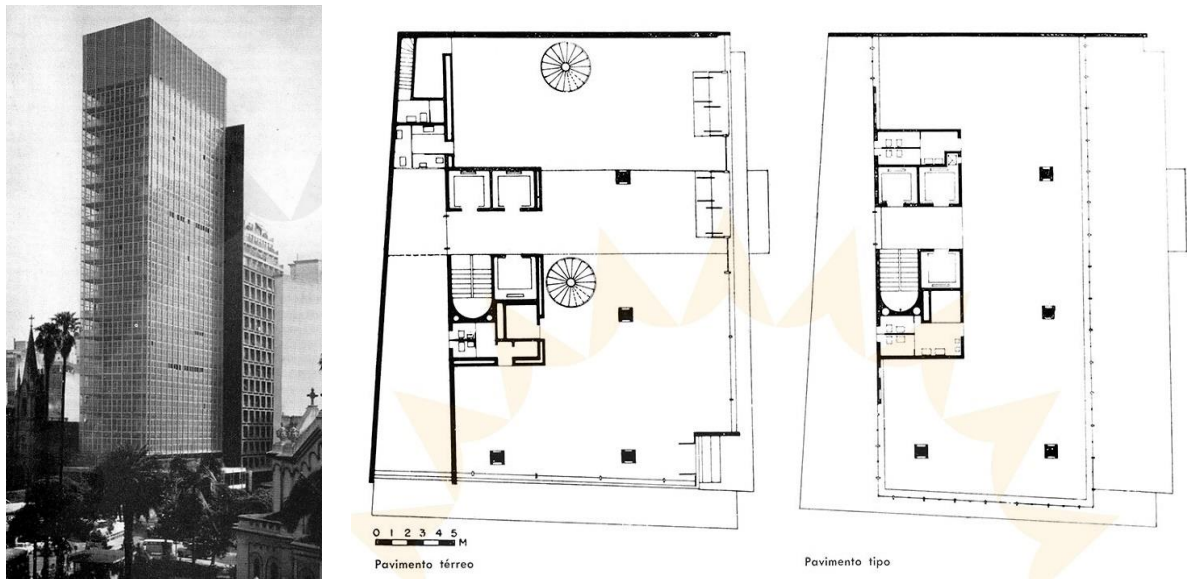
Vista del edificio Wilton Paes de Almeida y planos de planta baja y tipo (fuente: Acrópole Magazine, 1965)
